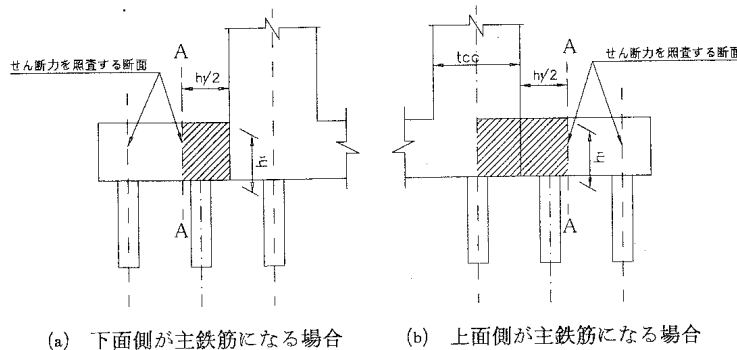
杭基礎フーチングのせん断力を照査する断面
